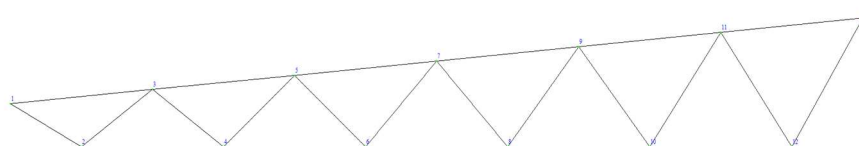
Расчетная схема фермы с нумерацией узлов
